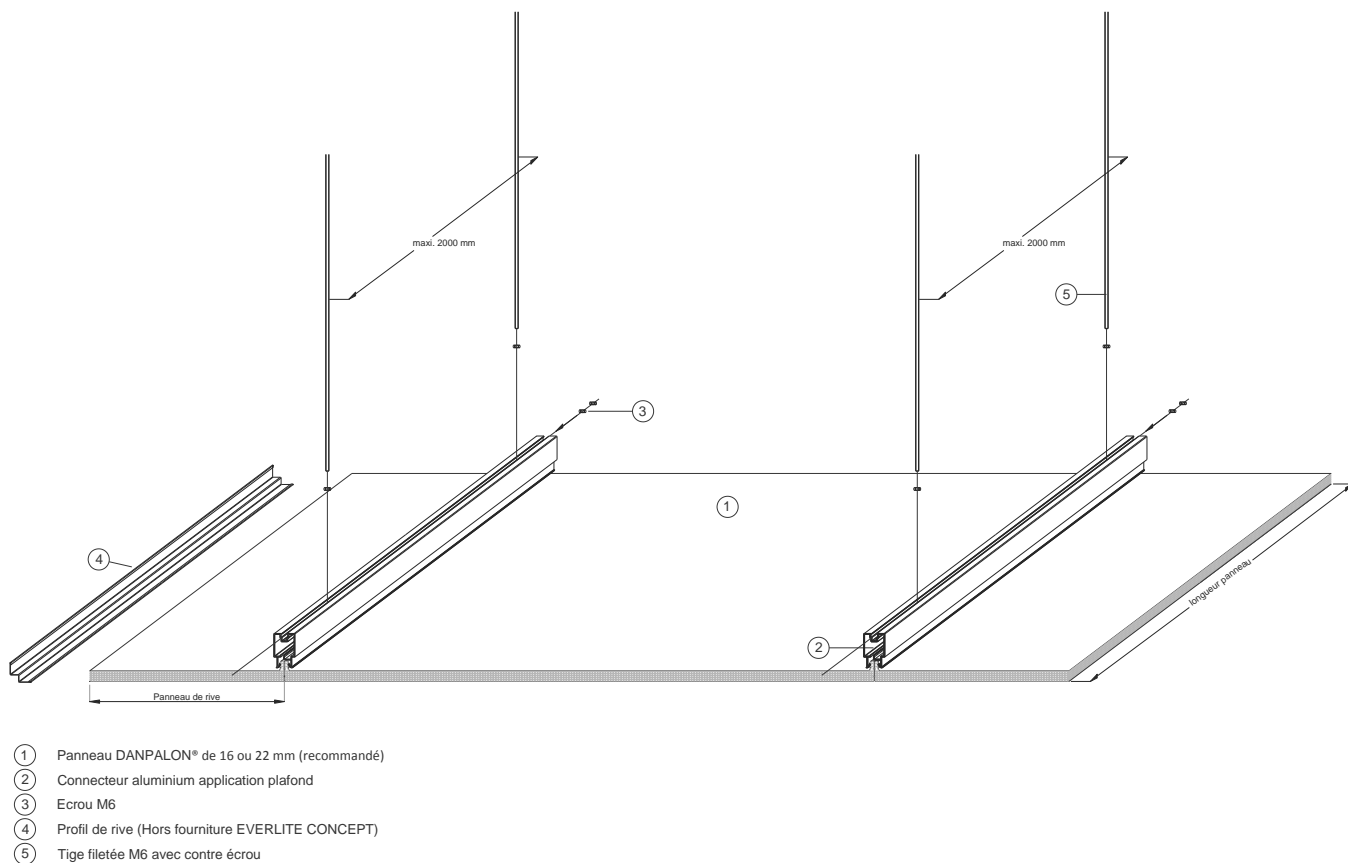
Connecteur plafond – système DANPALON® application plafond suspendue
